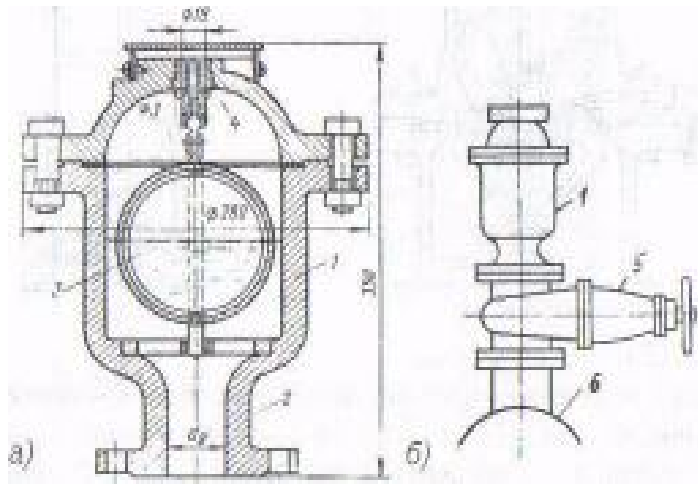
11. Вантуз: а — загальний вигляд; б—установка на водоводі; 1 — корпус; 2 — горловина; 3 — шаровий поплавок; 4 — клапан для випуску повітря; 5 — засувка; 6 - водовід
